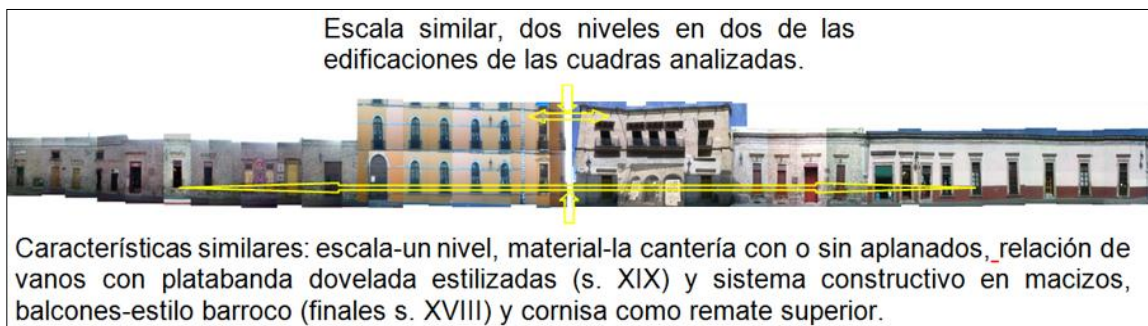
Alzados de fachadas norte de la manzana 3 al frente de la manzana 12 y fachadas sur de la manzana 12, características comunes de conjunto urbano.
